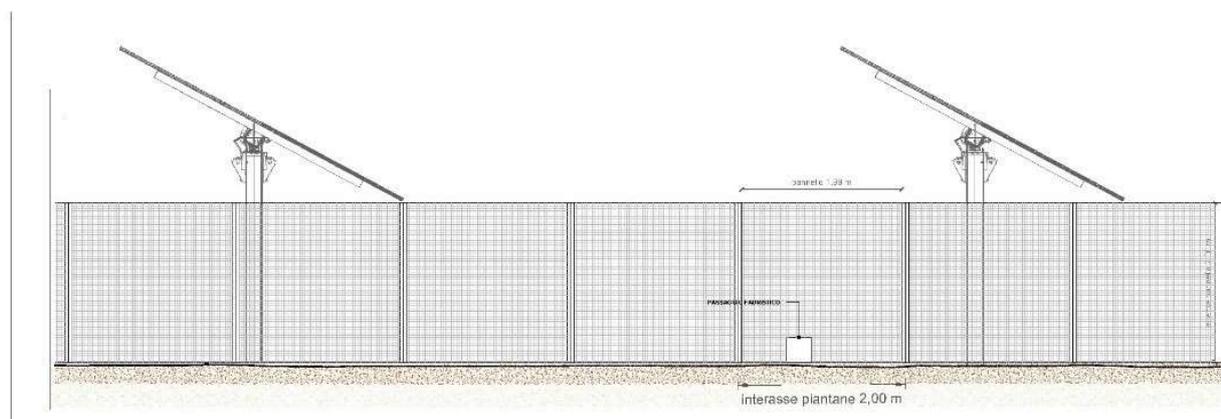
Prospetto recinzione perimetrale senza mitigazione
